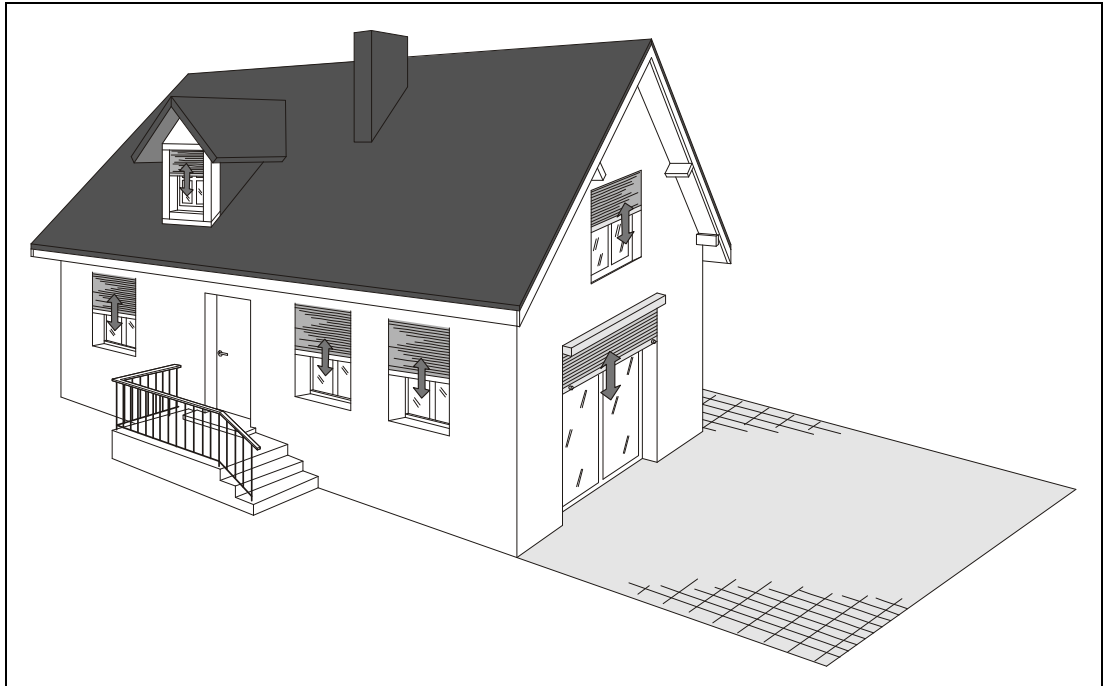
Prinzipskizze für eine Rollladensteuerung
